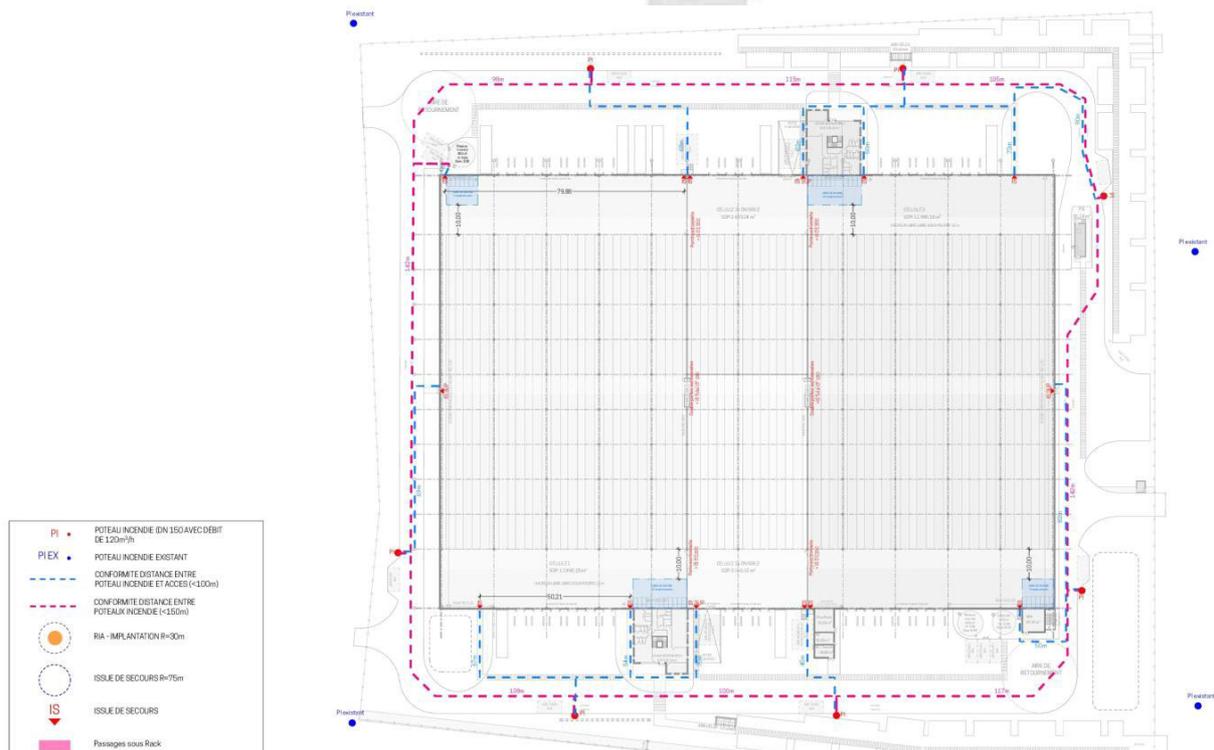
Localisation des poteaux incendie sur site et hors site
